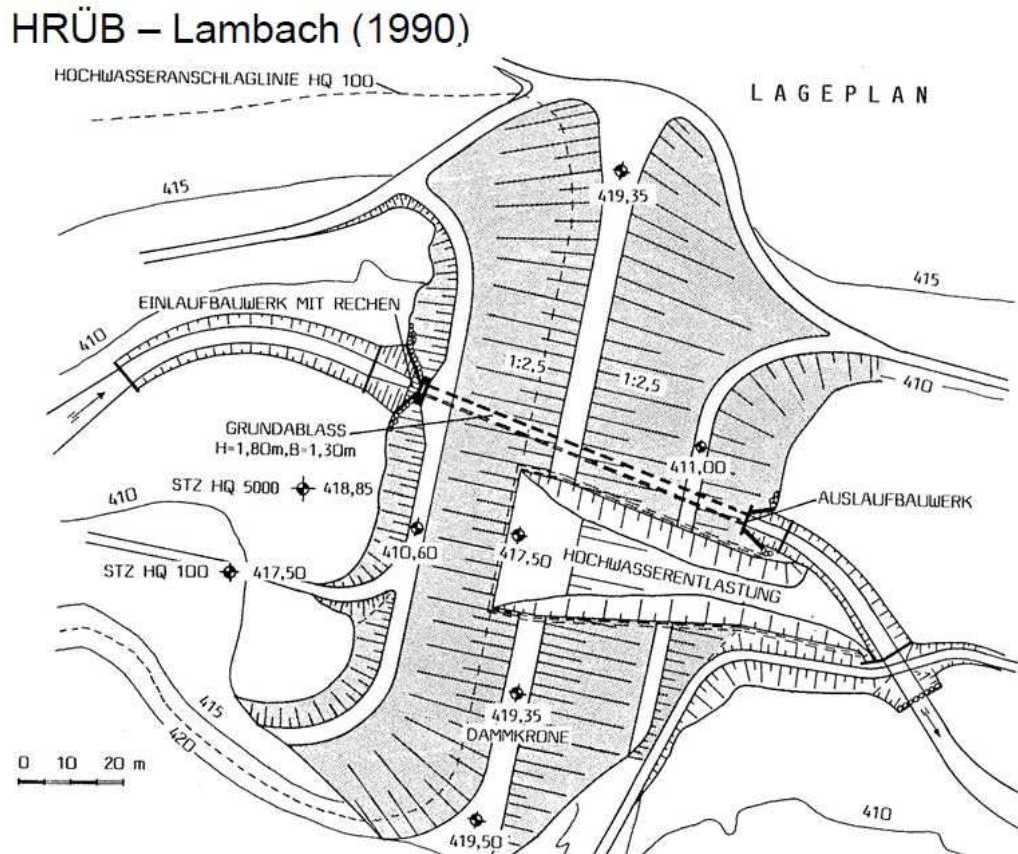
Hochwasserrückhaltebecken Lageplan³⁷
